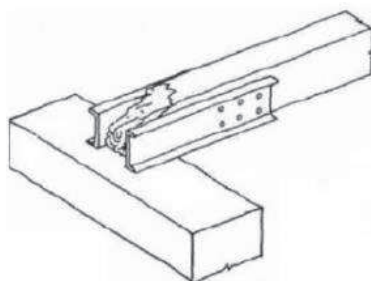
Reforço com vigas metálicas fixadas às vigas de madeira existentes [48]
